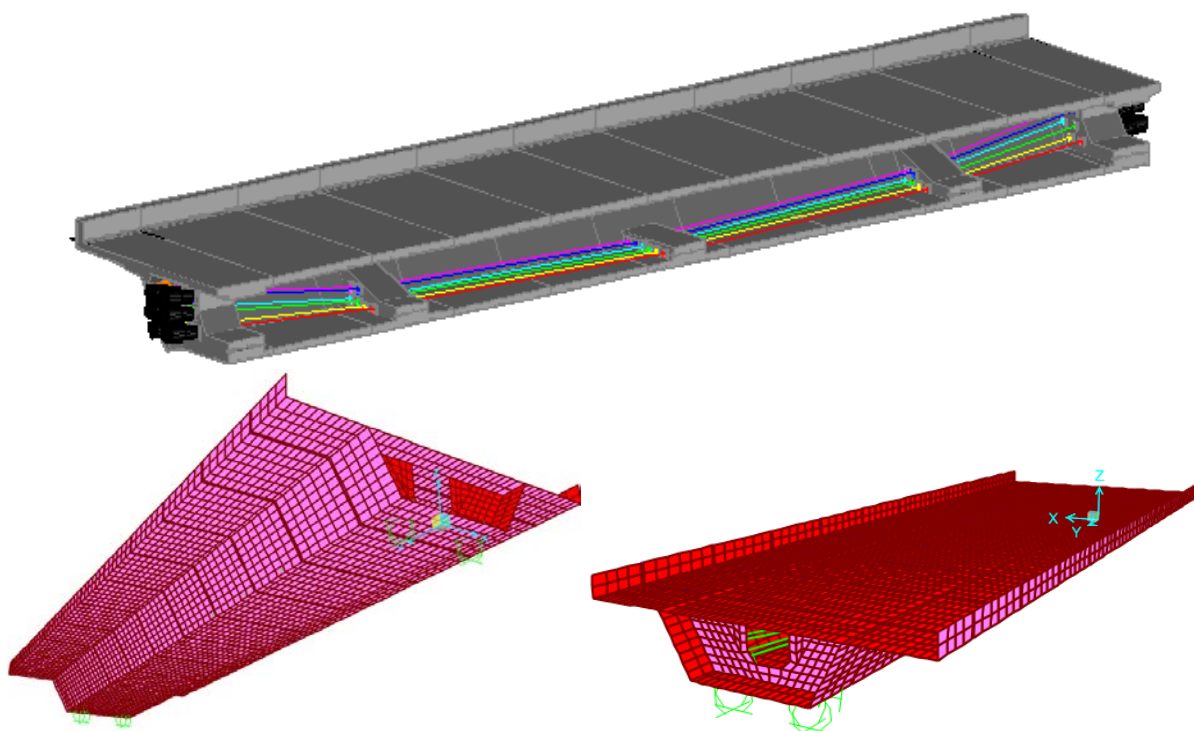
Modelo de elementos finitos de la viga cajón con postesado externo.
